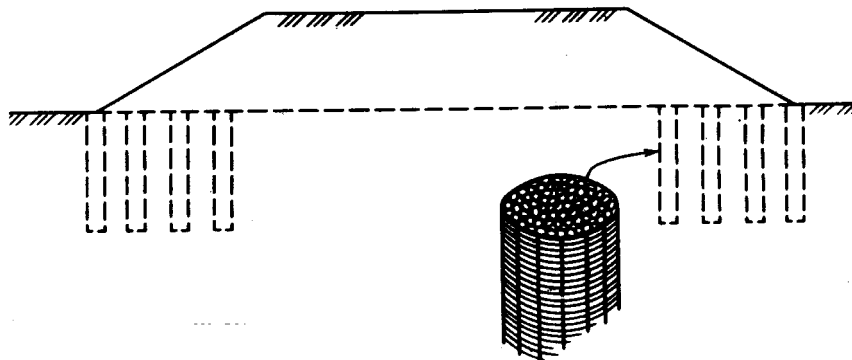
Армирование при вертикальной планировке в условиях города
